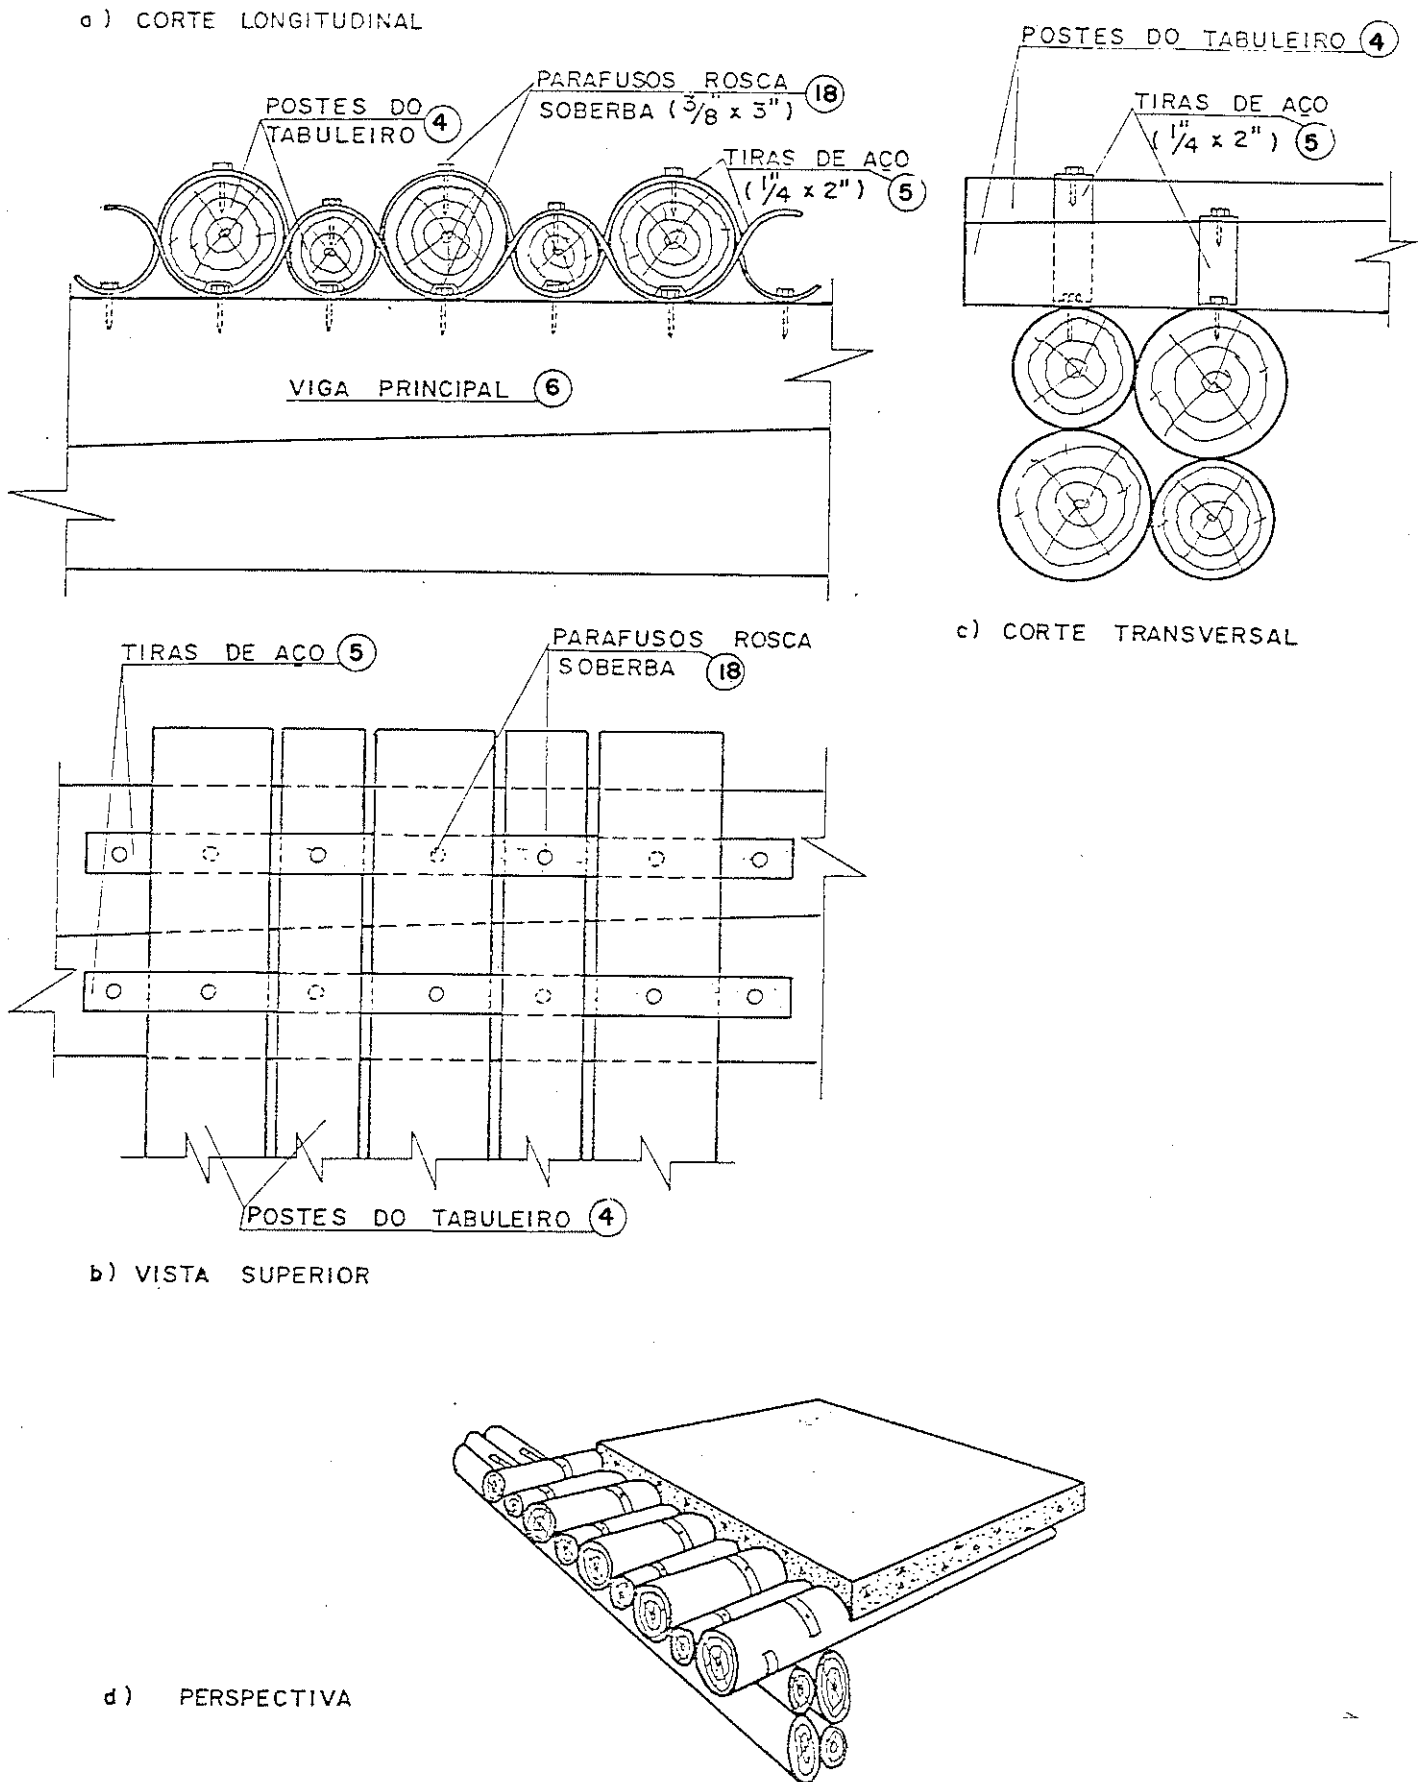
LIGAÇÃO DOS POSTES DO TABULEIRO NA VIGA PRINCIPAL
